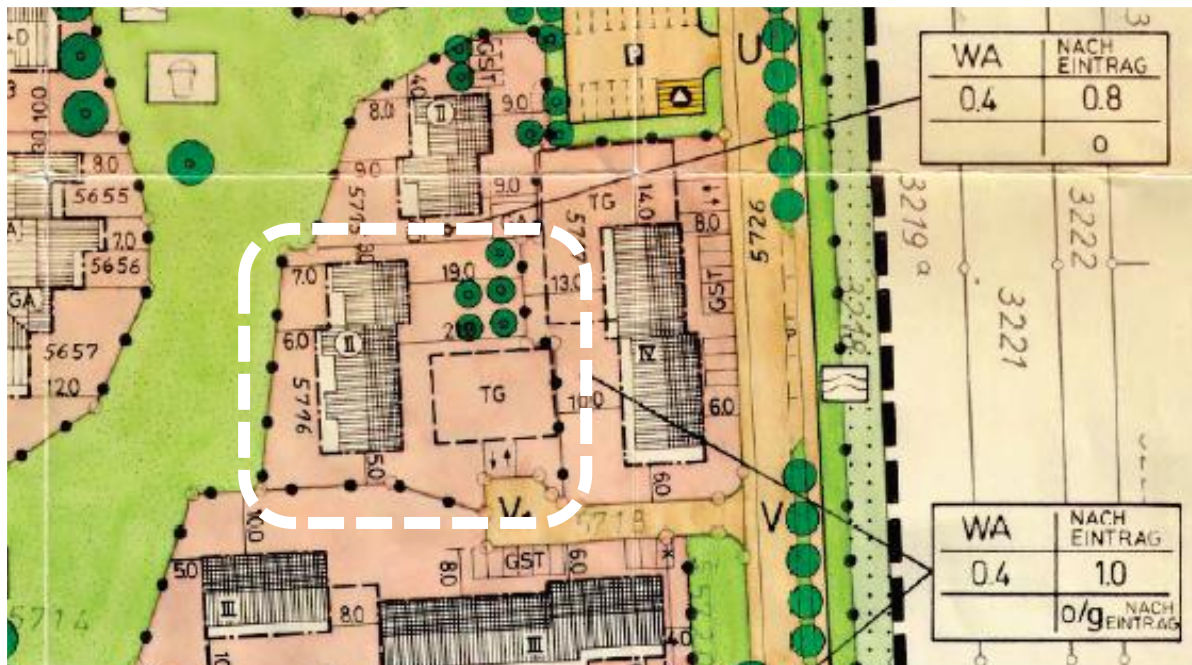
Bebauungsplan „Neumatt-Nord“, Änderungsbereich weiß hervorgehoben
